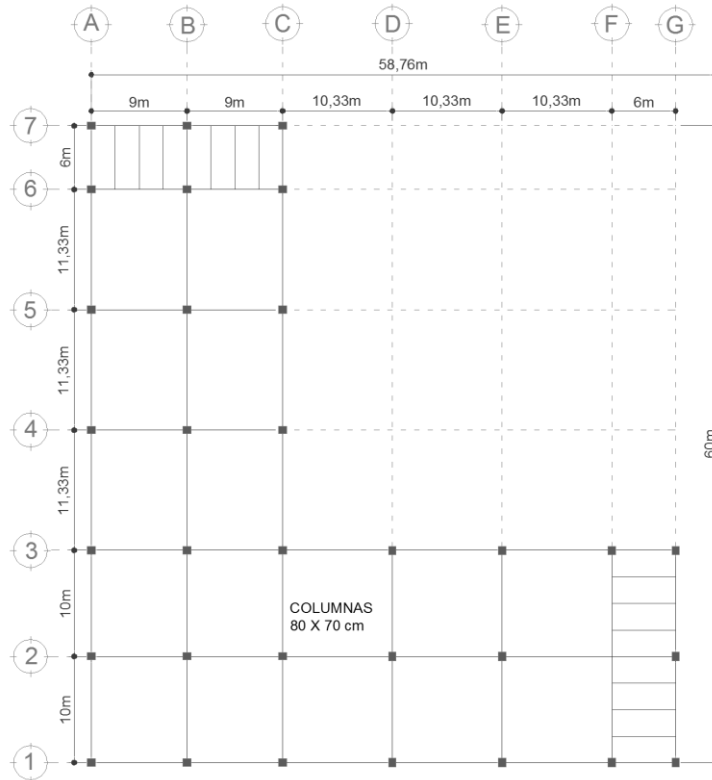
Columnas propuestas del nivel 8 al 10 para la estructura de concreto.
